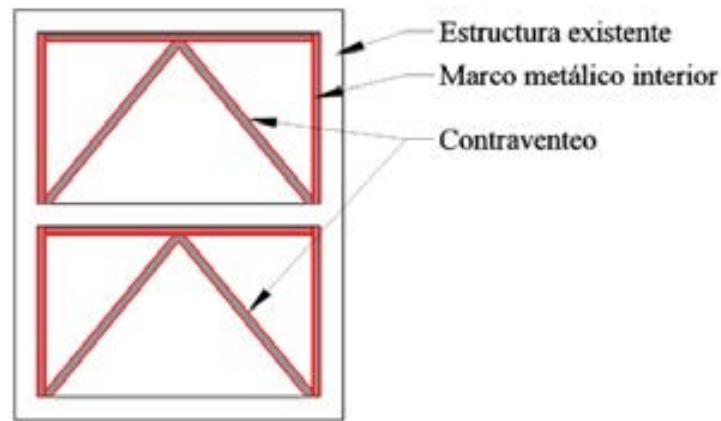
Contraventeos tipo V invertida con marco metálico conectado a un marco de concreto
